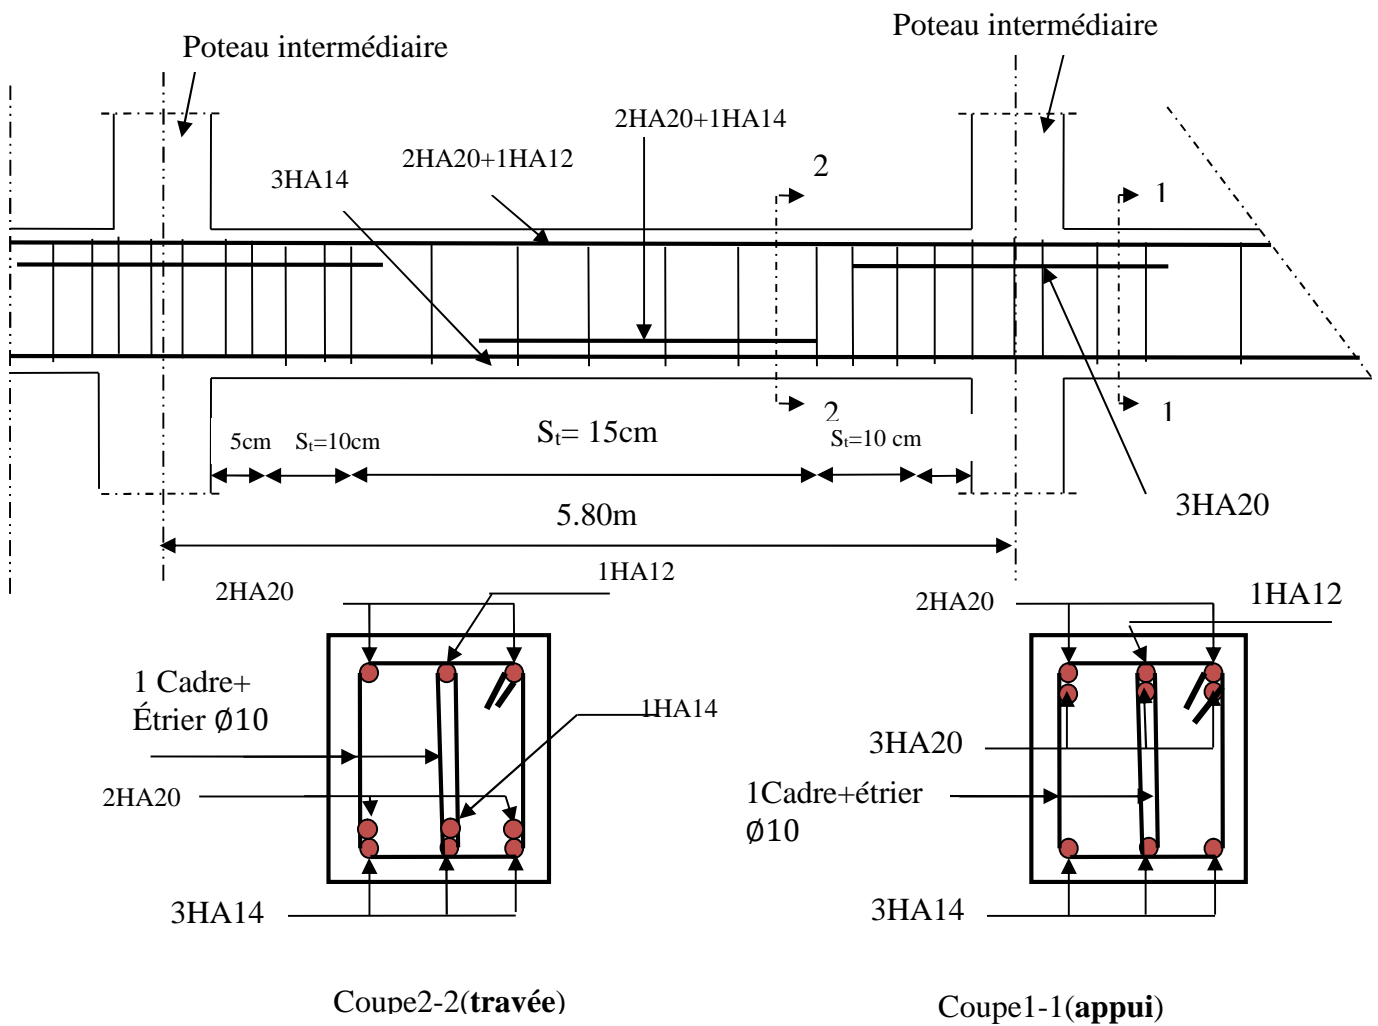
Schéma de ferrailage des poutres principales de RDC
